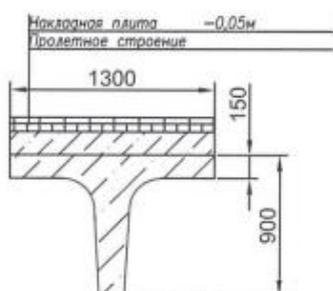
Сечение балки с накладной плитой из сверхпрочного бетона В150
